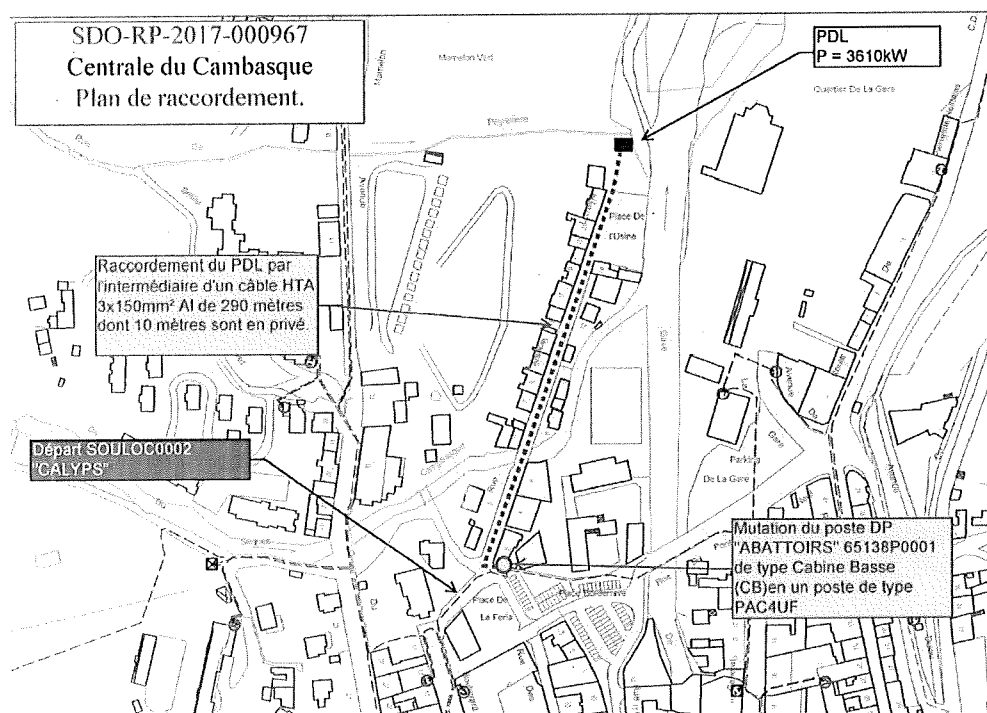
Plan de raccordement du projet au réseau électrique (source : ENEDIS)
